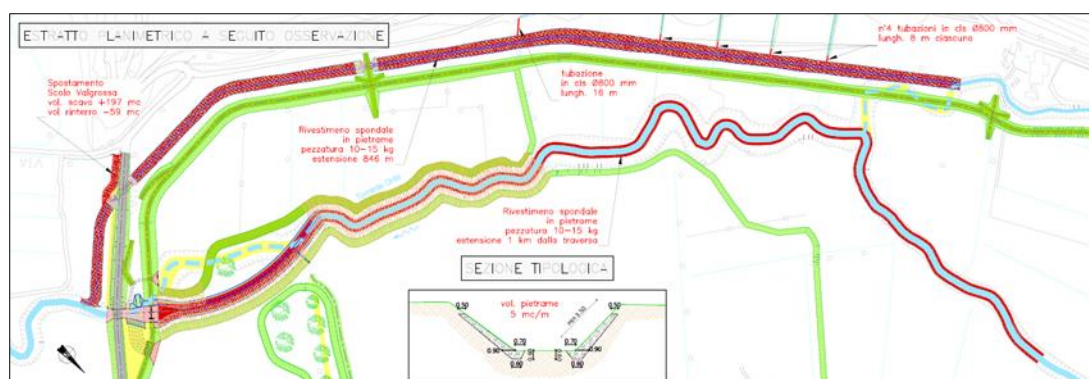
Estratto planimetrico dell'intervento di spostamento del tratto finale del T. Onte
